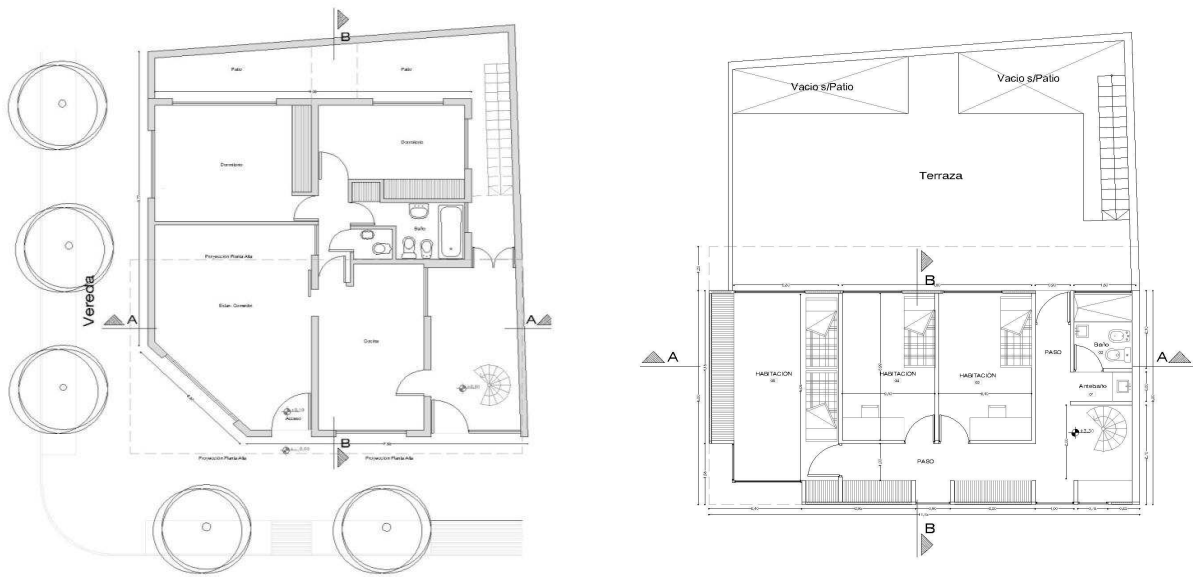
planta de vivienda existente y de la ampliación bioclimática en planta alta
